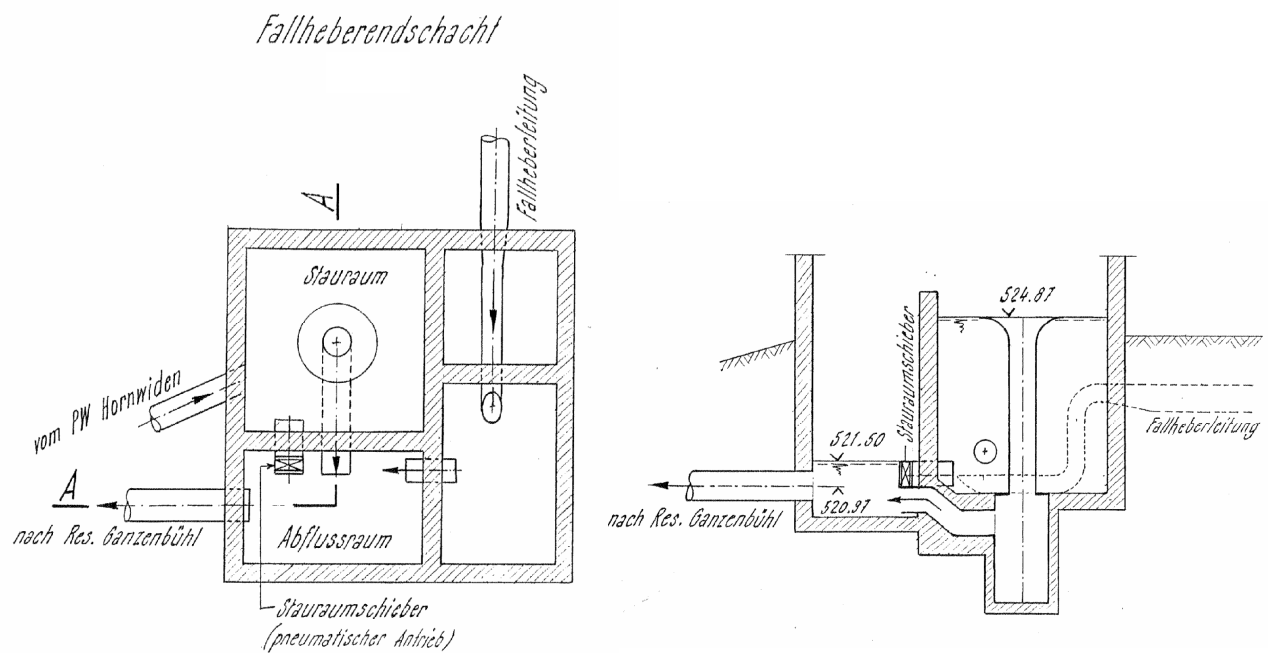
Fallheberendschacht Grundriss und Schnitt
